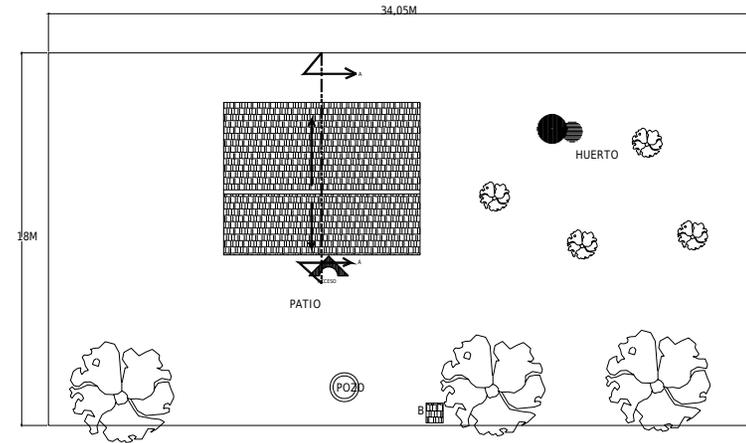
PLANTA DE CONJUNTO CORRESPONDIENTE A LA FICHA No. 8.
